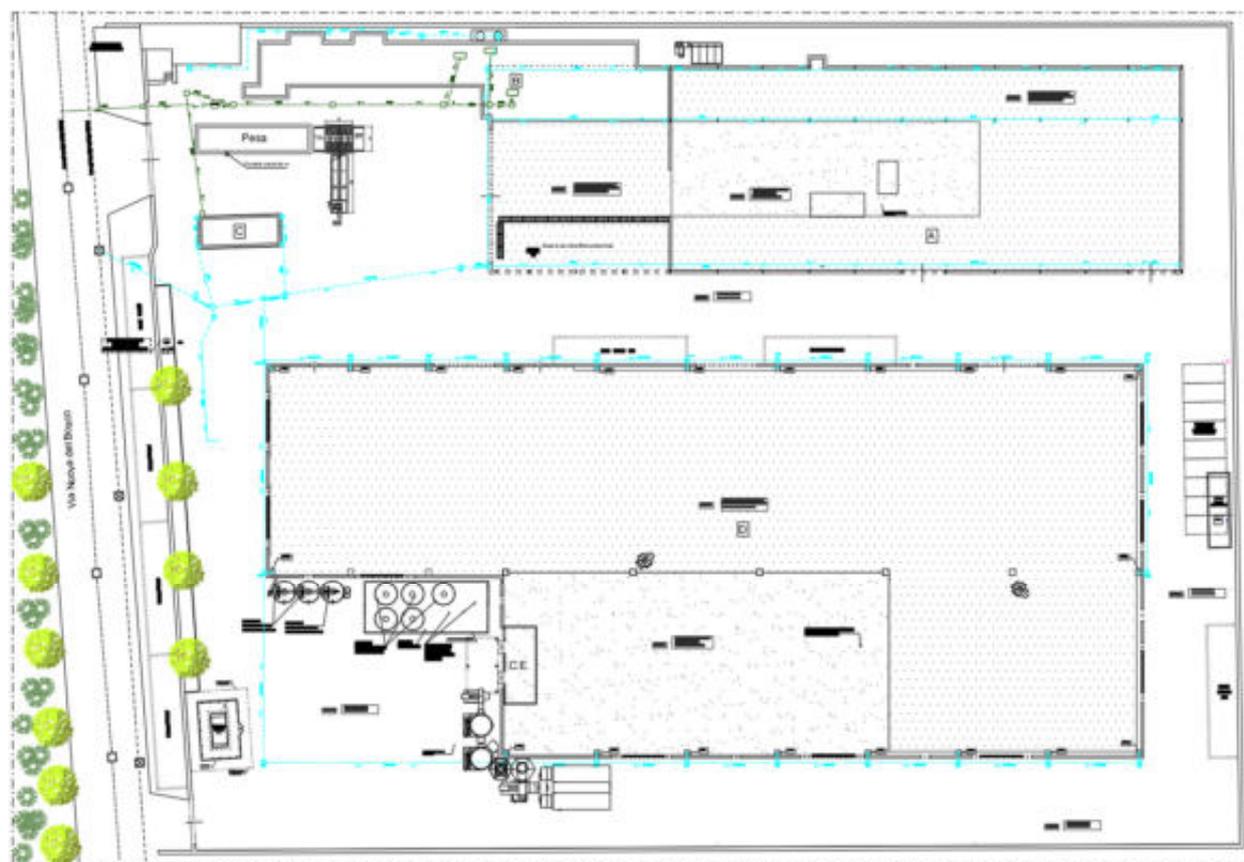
Estratto fuori scala dell'allegato Allegato T – Planimetria punti di approvvigionamento acque e reti degli scarichi idrici”
